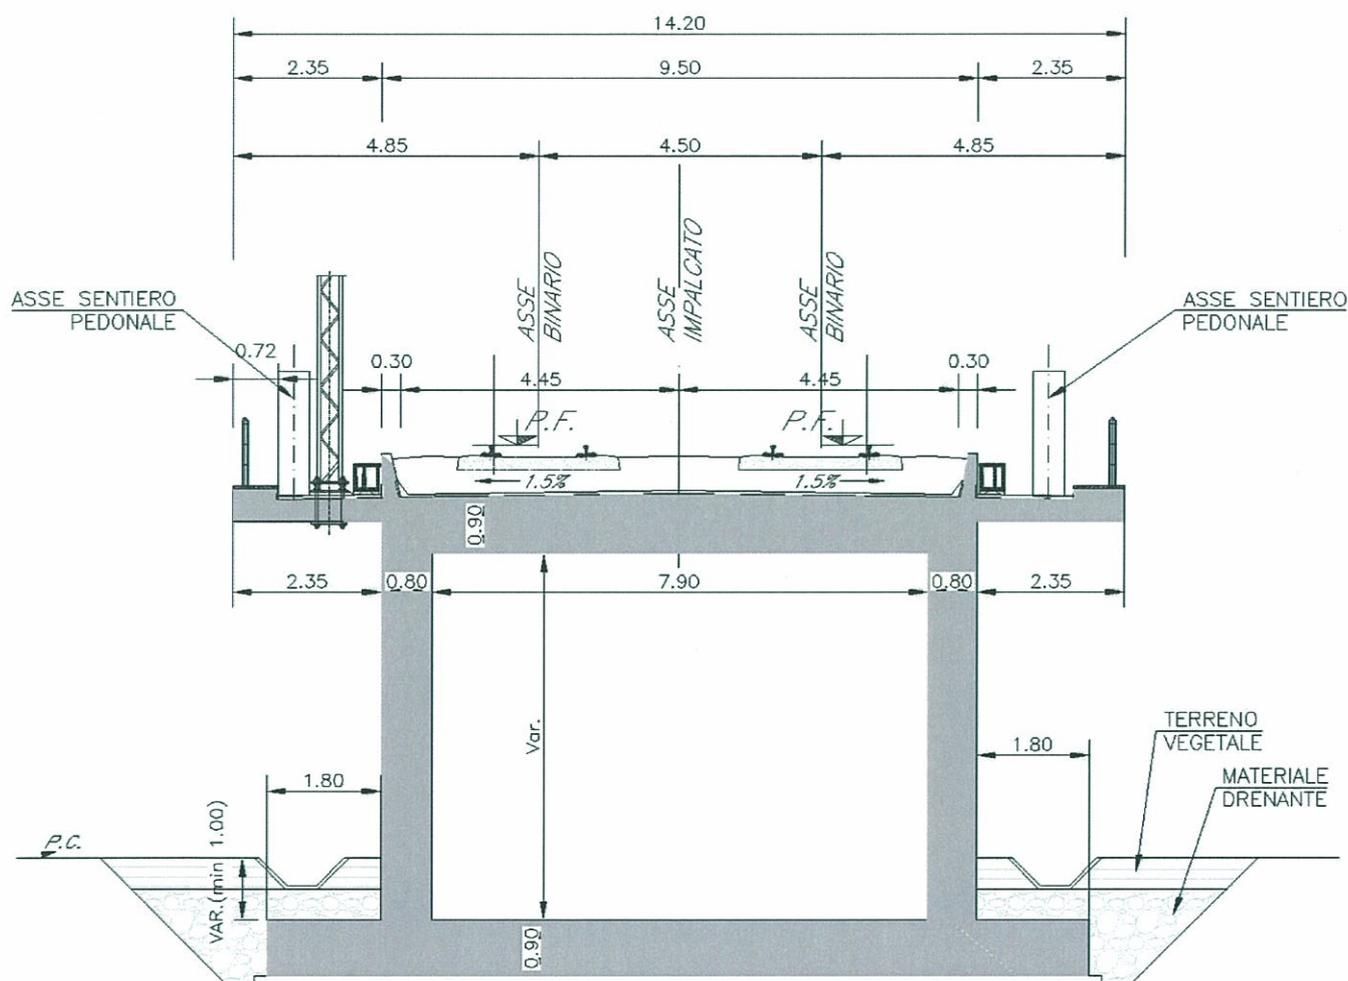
Sezione trasversale dello scatolare a doppio binario.
